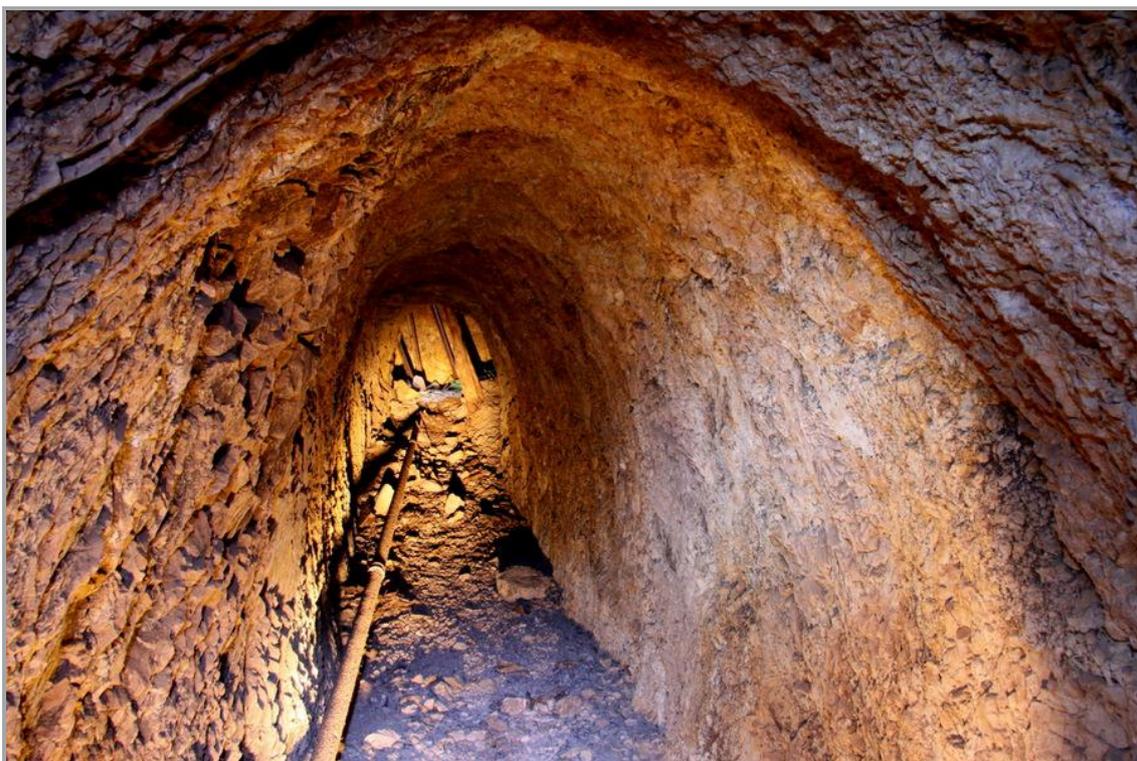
Entronque de la chimenea de ventilación de la Galería Diana (Fot. J.M. Sanchis, 2008)
